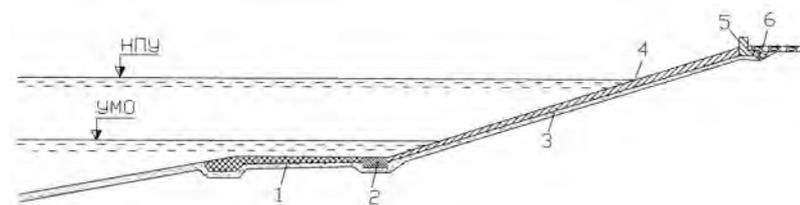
Пример конструкции откосного крепления из монолитного или сборного омоноличиваемого железобетона на подготовке:
